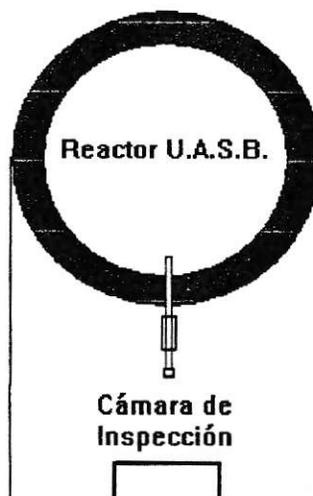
Vista de Planta de la Cámara de Inspección.
